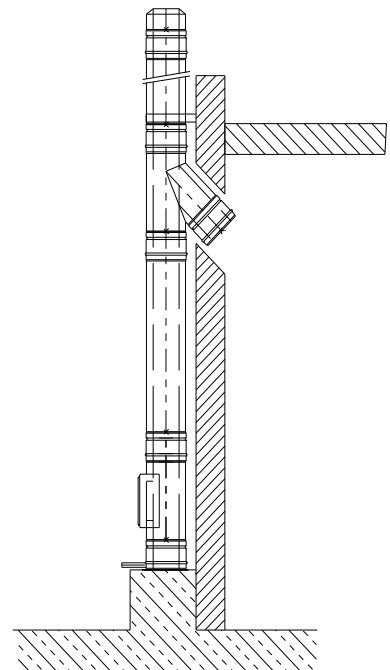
Aufbau mit Grundplatte für Sockelmontage
